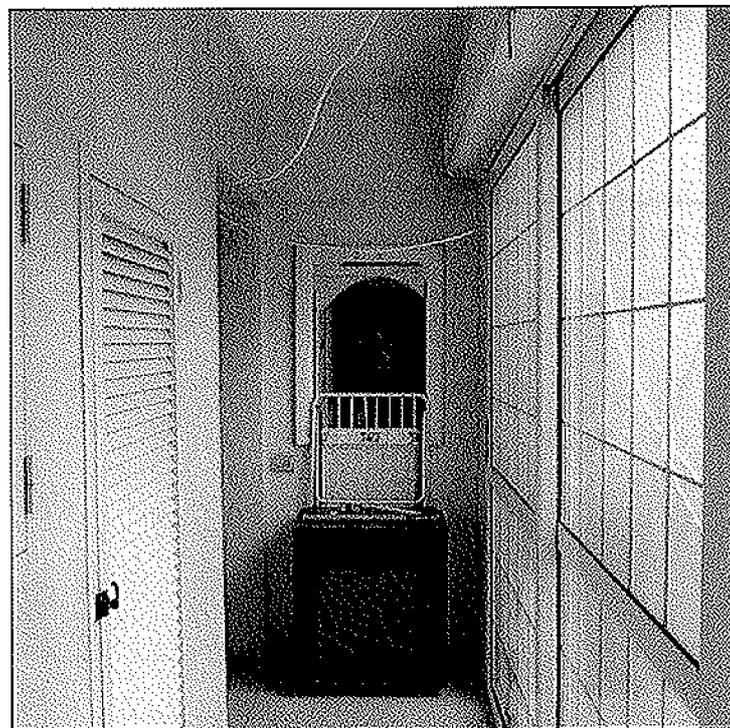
corridoio appartamento piano terra via Redipuglia n. 108 - affaccio cortile interno
